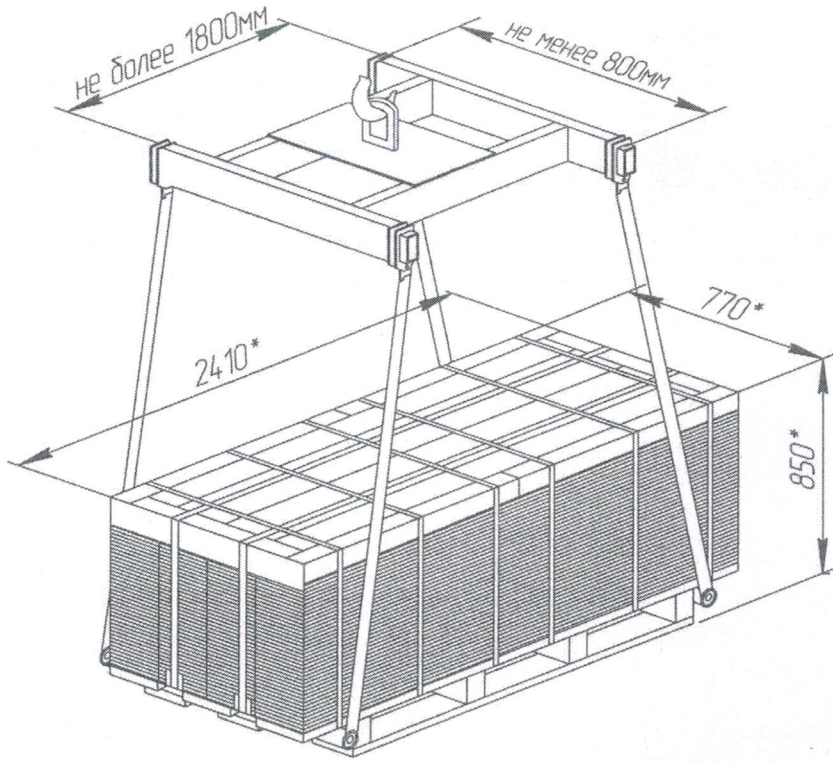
Схема строповки пакета траверсой с жесткой подвеской
